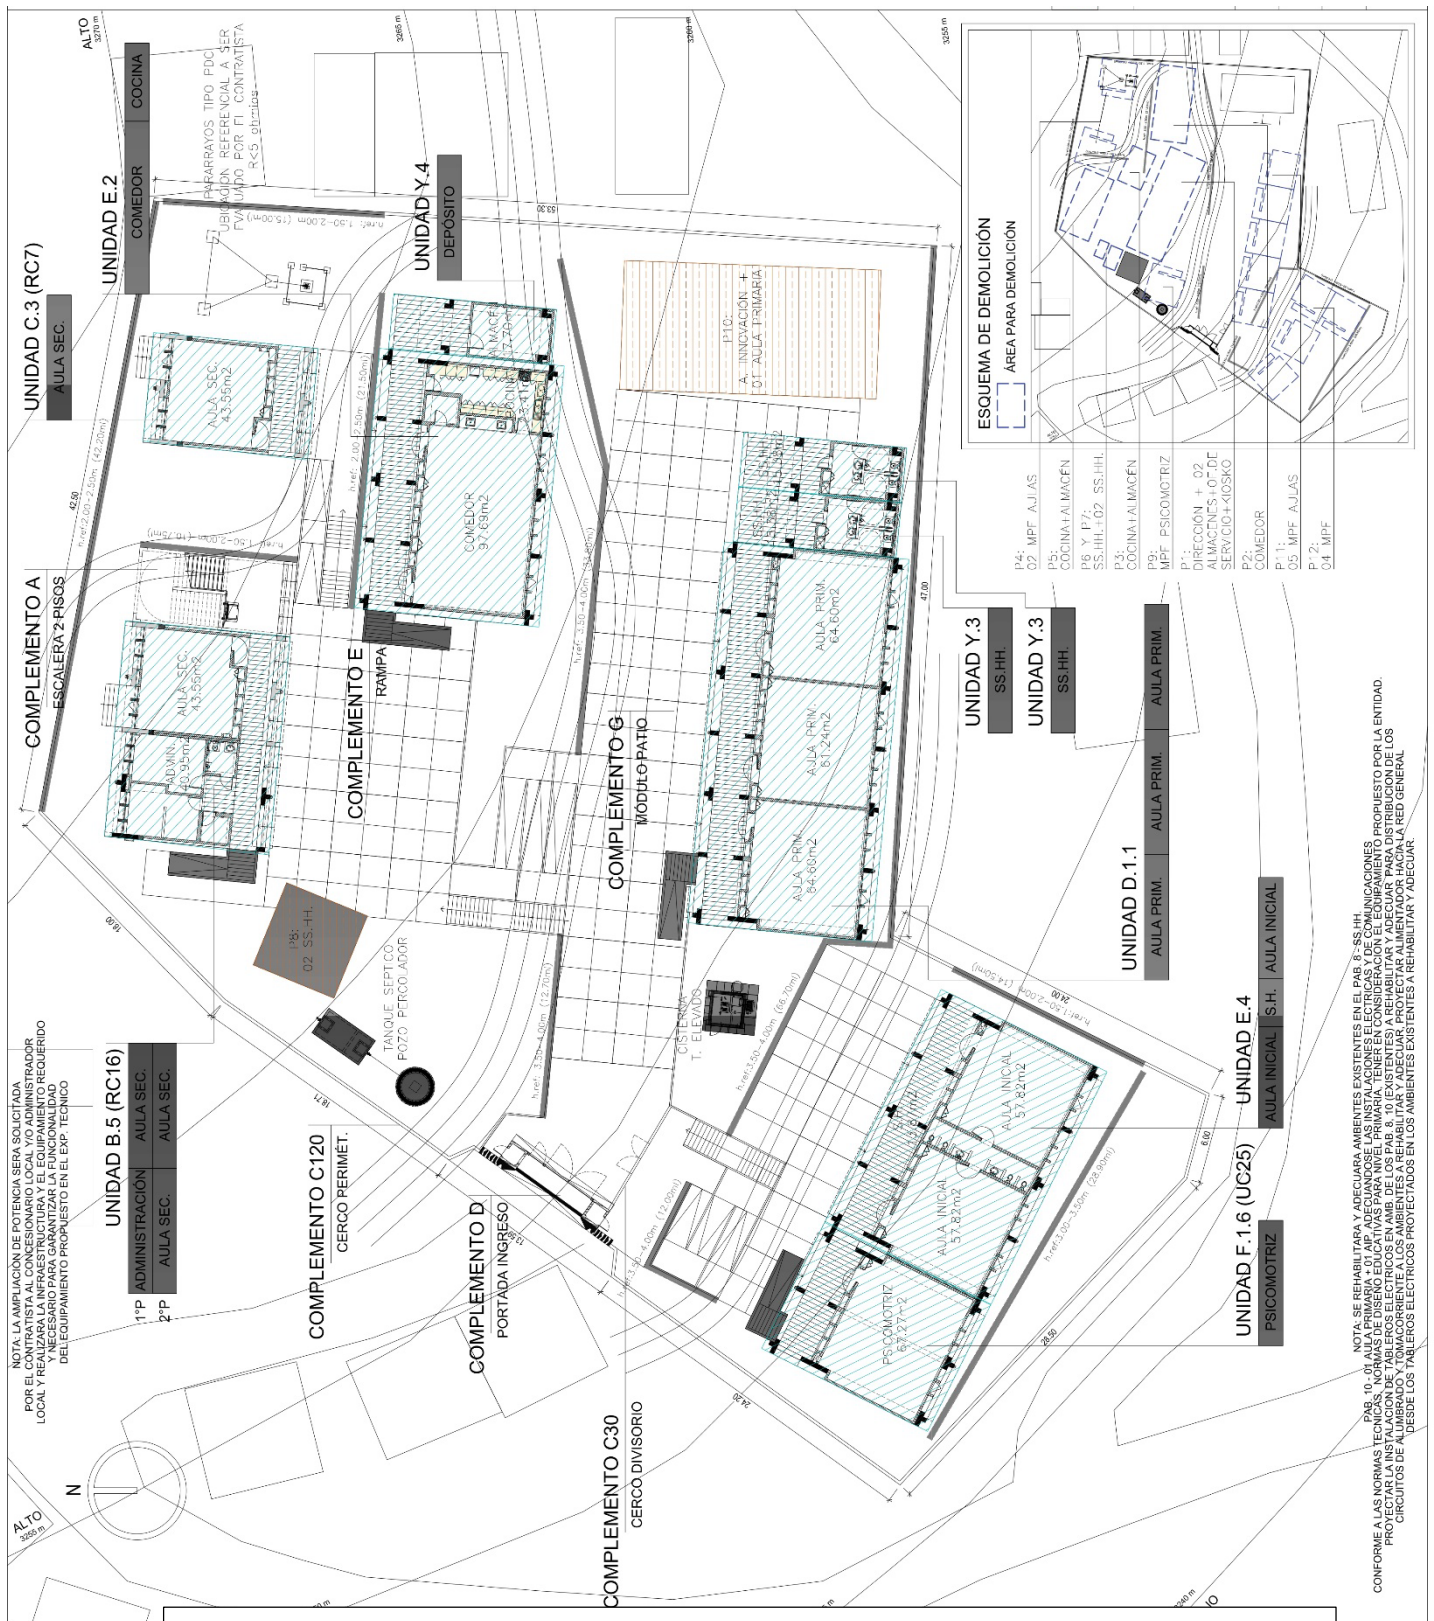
CL 040534- Planteamiento de Cabida desarrollado por el equipo UGRD. Fuente: Planteamiento UGRD 2022 – Elaboración propia.
